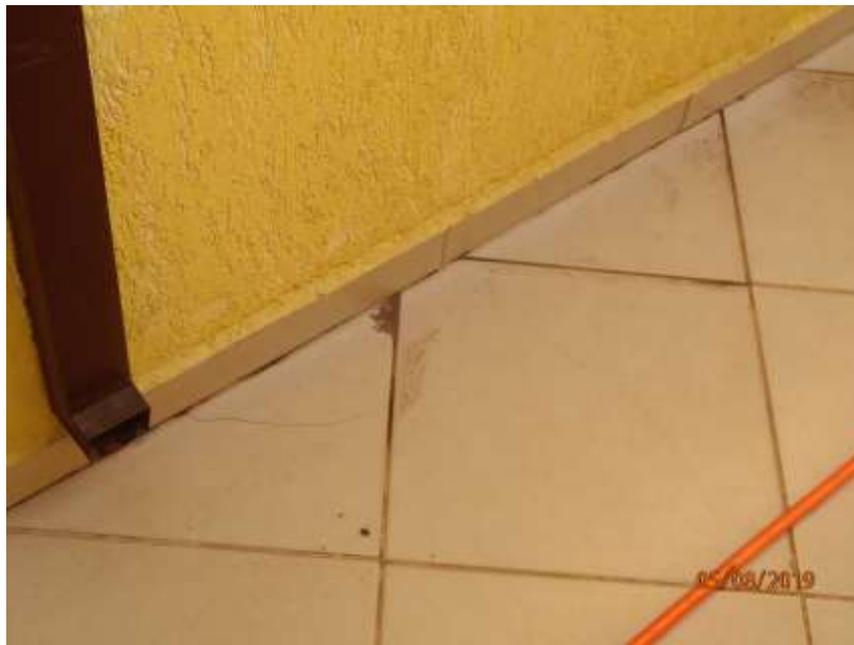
Detalhe de pontos de infiltração e fissura no piso
